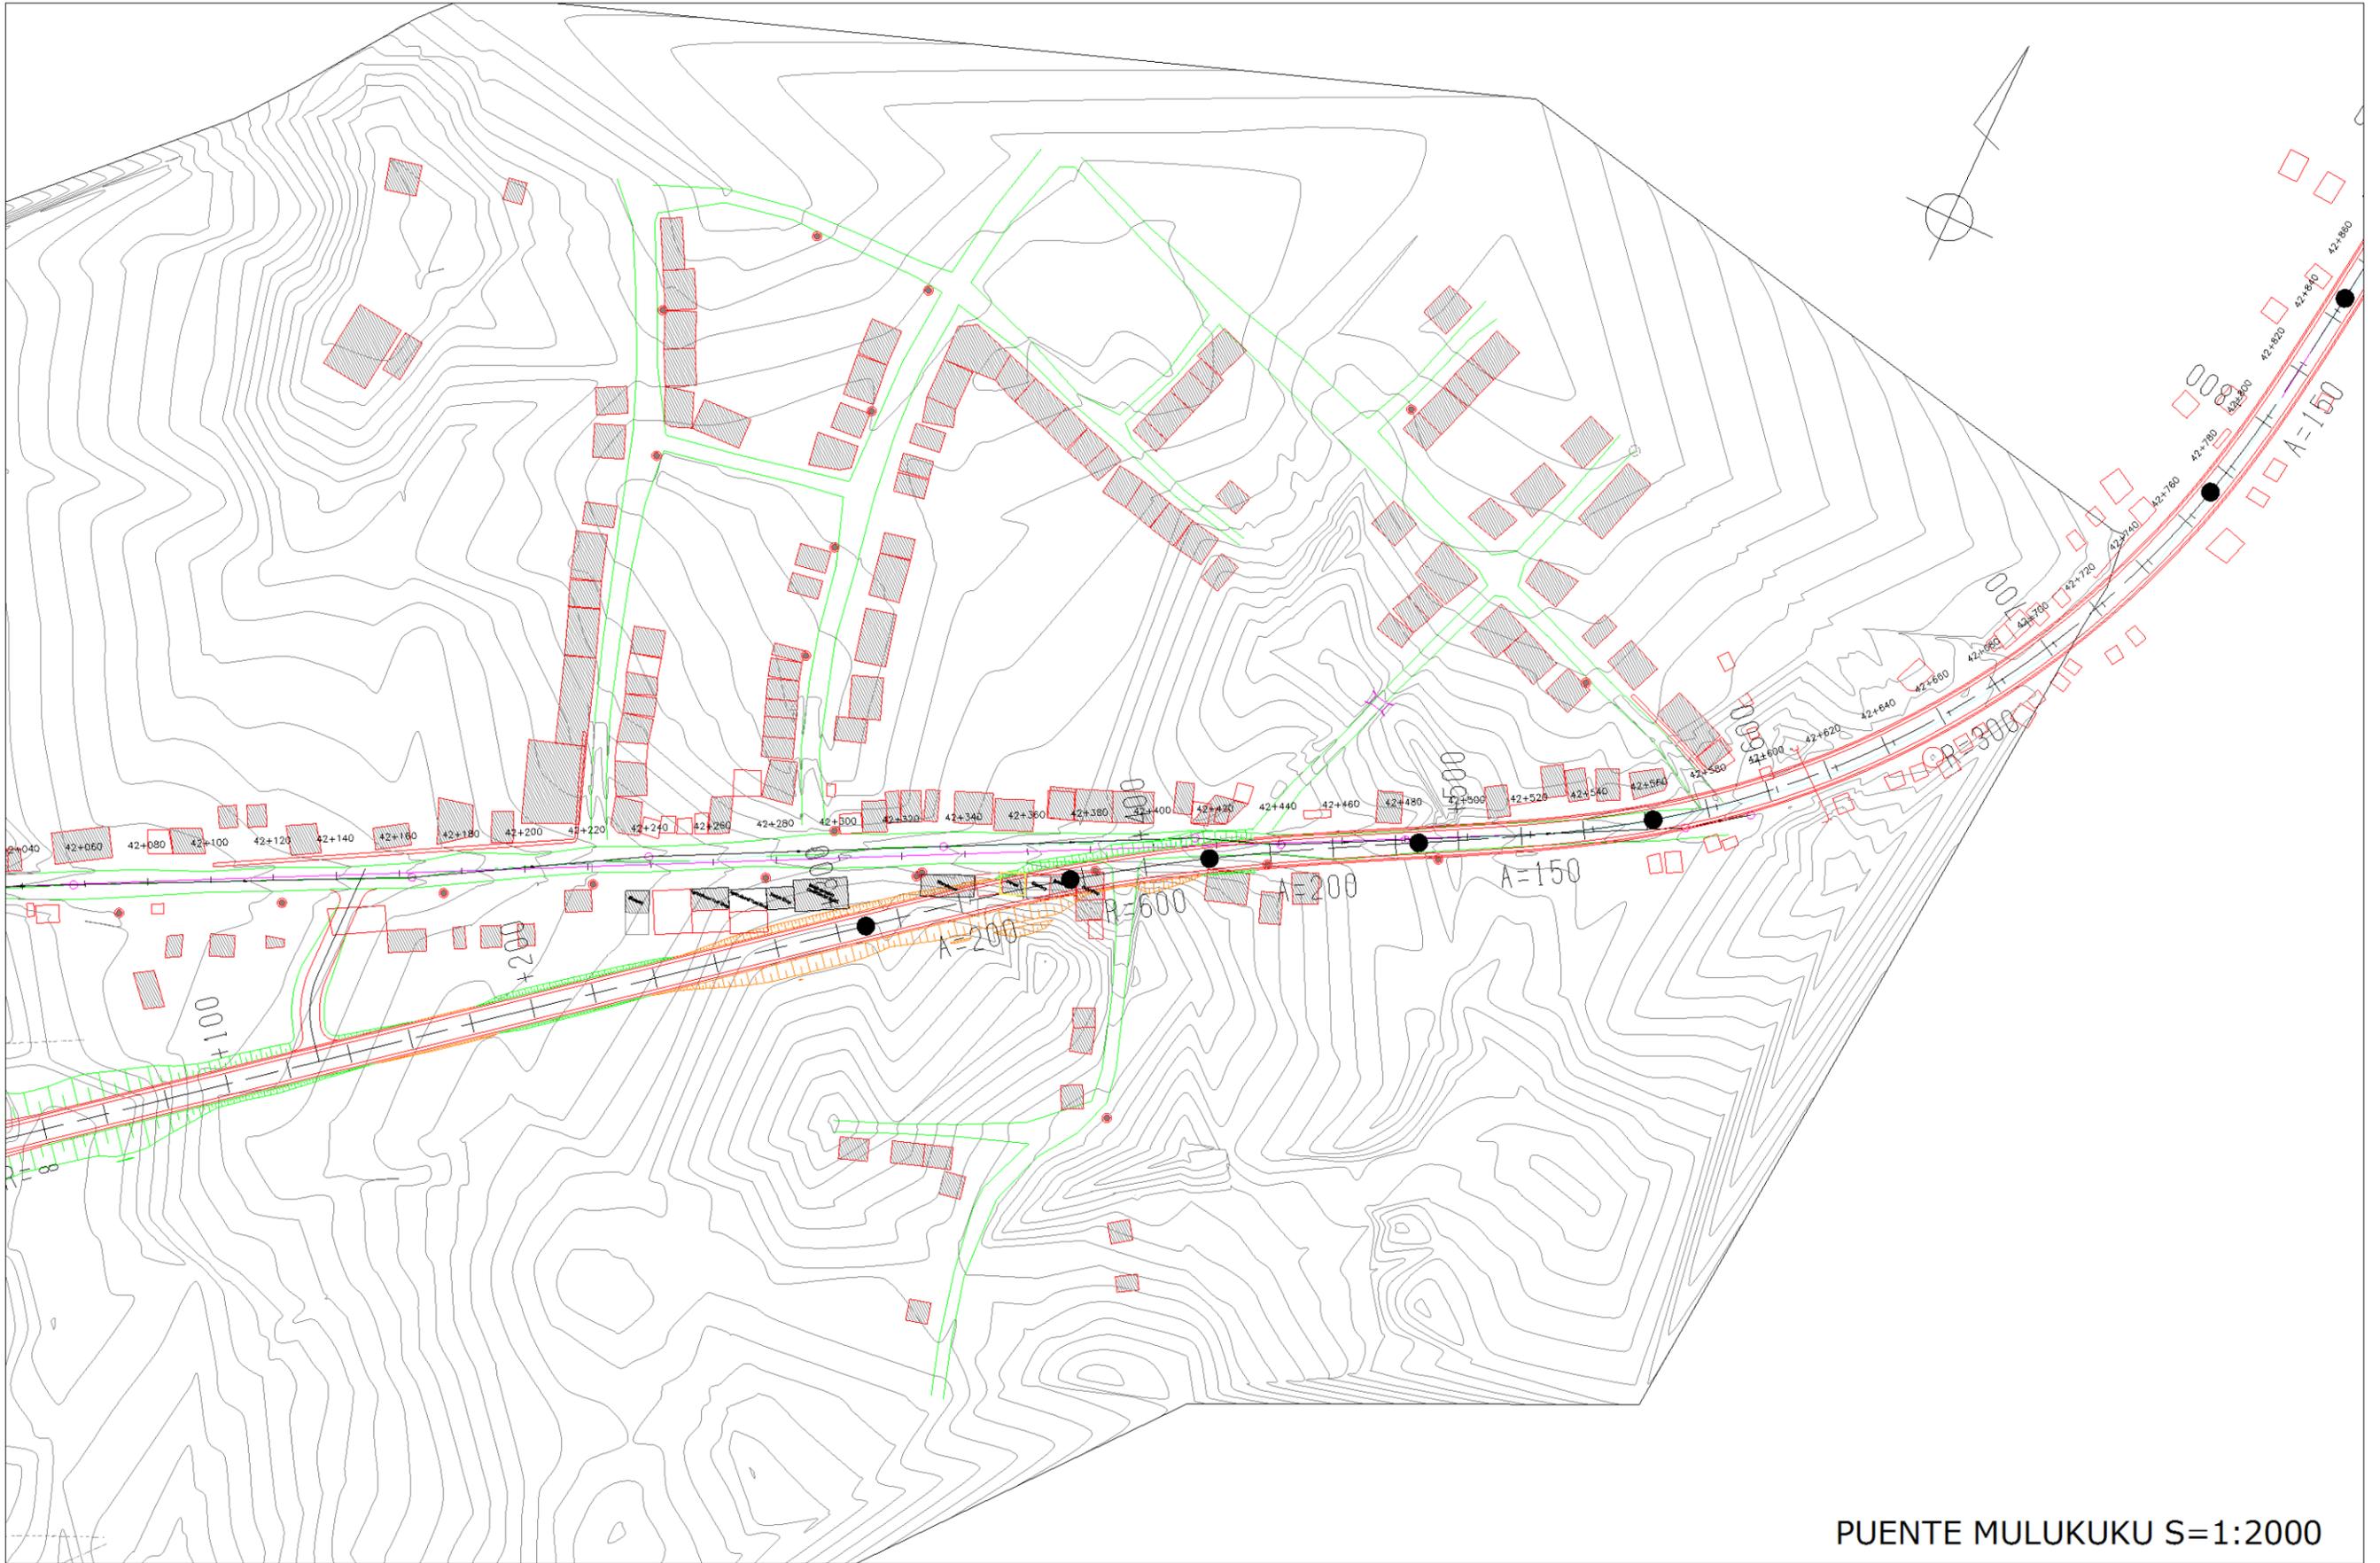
架橋位置平面図 (ムルクク橋 (2/3))
